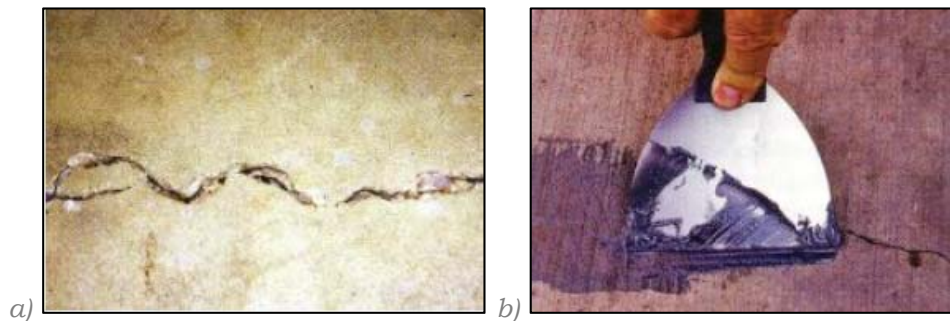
a) Limpieza y anchura de esta grieta (> 1.6 mm) la hacen idónea para relleno. b) El relleno epóxico se coloca con una espátula de metal flexible. (Trout, 2005)
